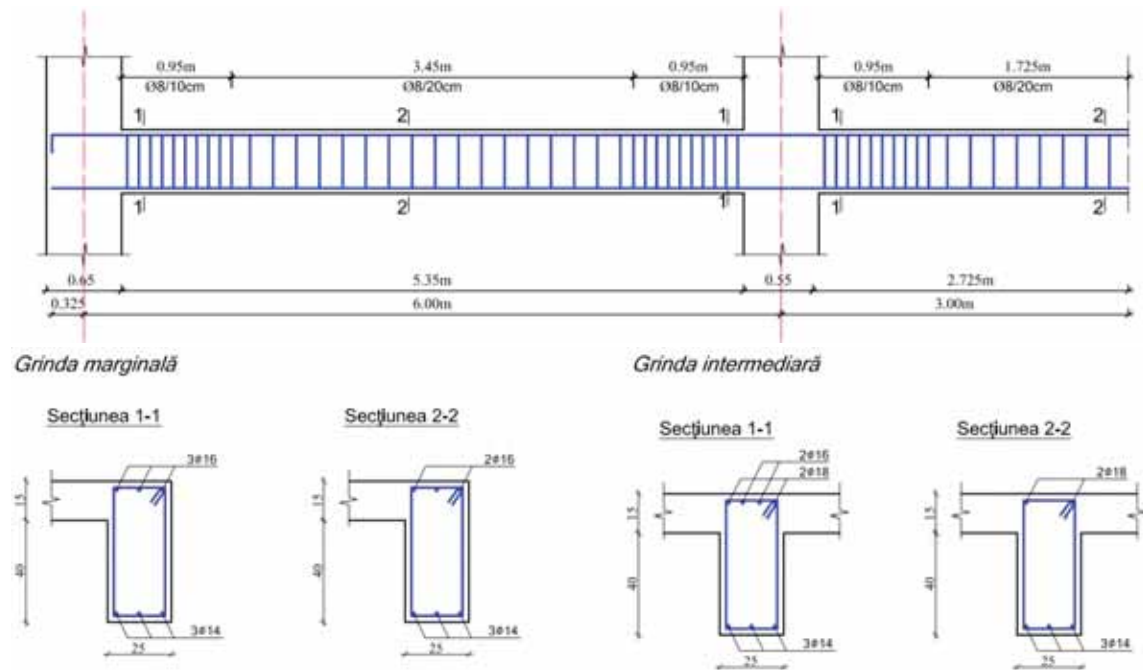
Structură P+8E: plan armare grindă longitudinală/transversală b.a.
